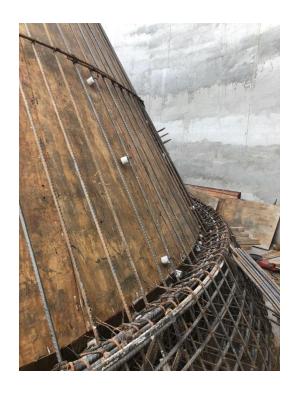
Tendido de acero de lecho interior de cono de concreto reforzado.
